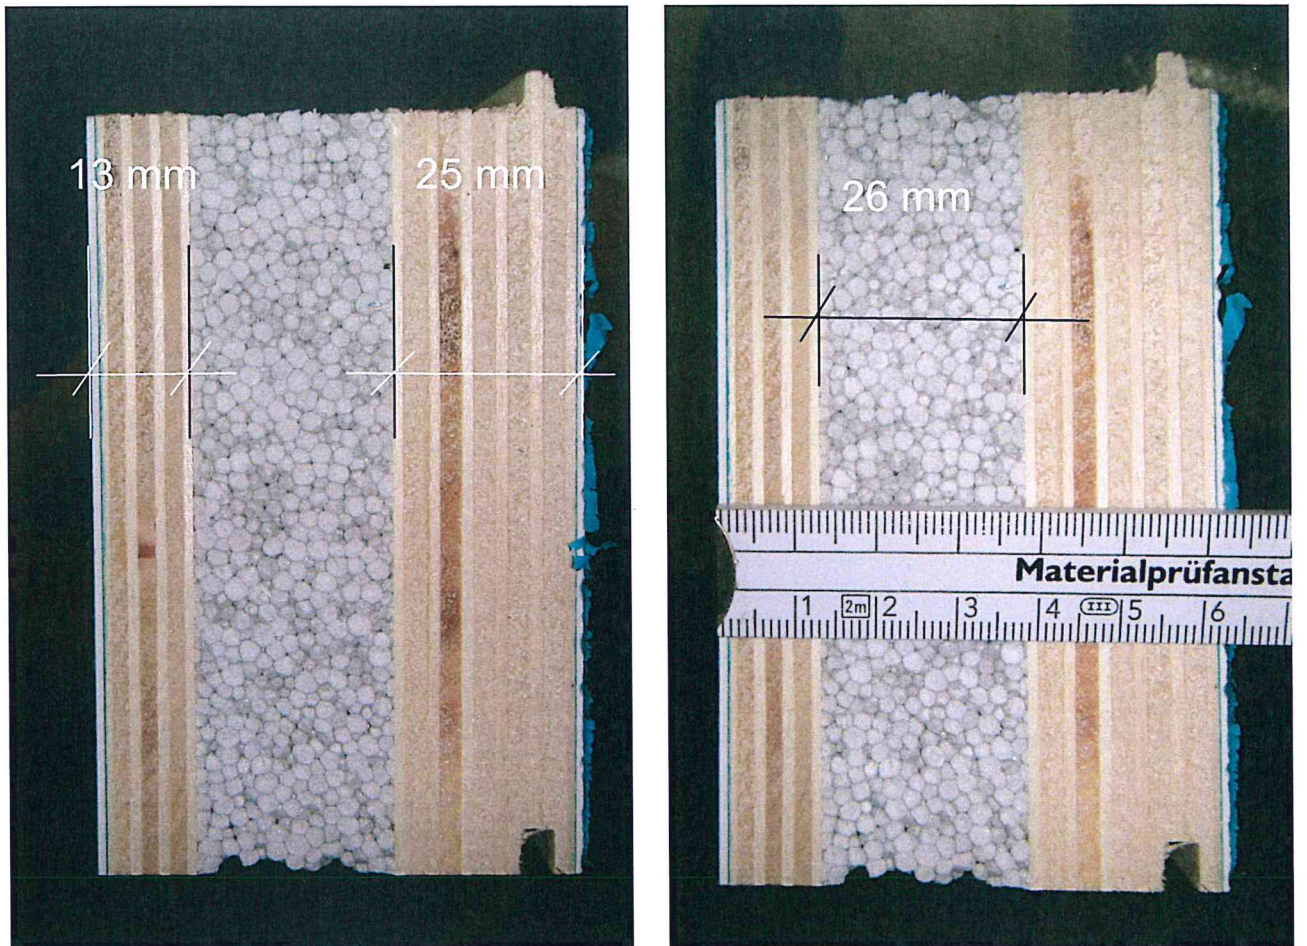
Ansicht und Detail blaugelb Sockeldämmprofilen (PVC/EPS), $d_{\text{Profil}} = 64 \text{ mm}$
